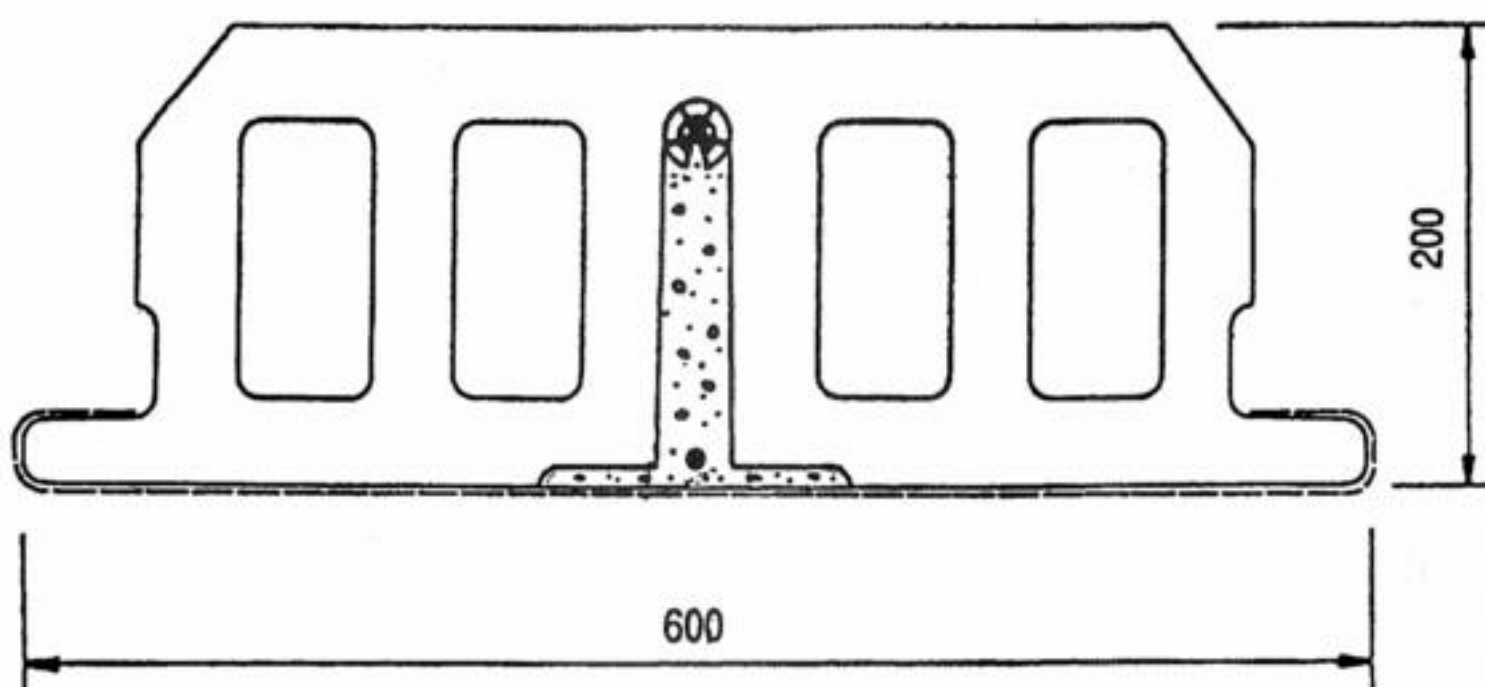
Элемент опалубочный перекрытия шириной 600 мм.
